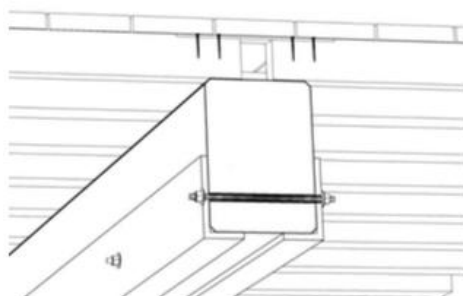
Reforço por perfis “L” ou cantoneiras fixos na face inferior da viga (Mariani, 2004).
